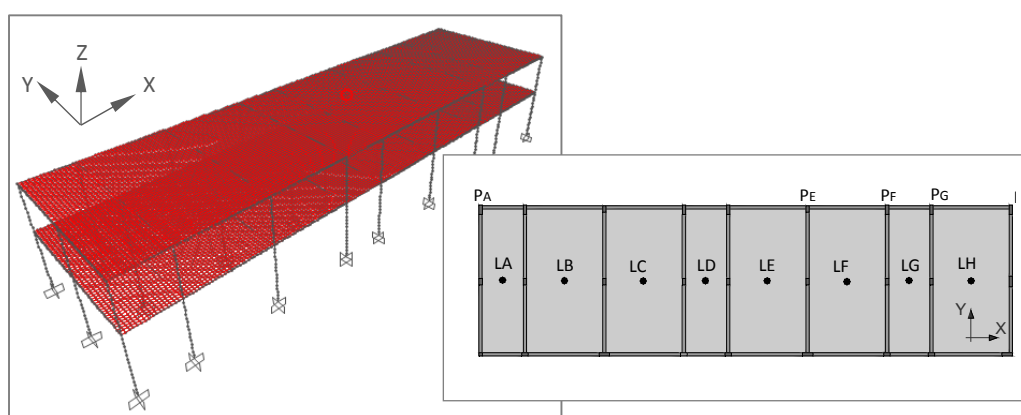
Planta da estrutura global tipo “A” e respetivo modelo de elementos finitos
